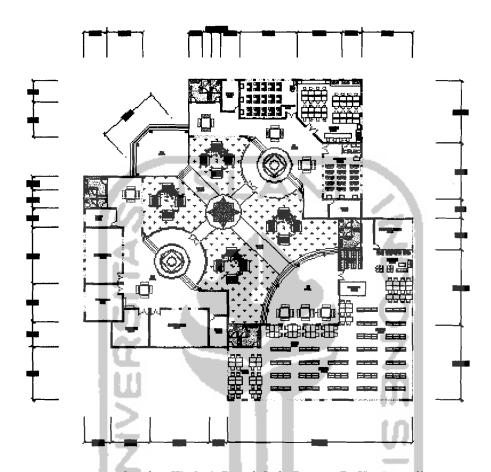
3. ii. Denah Kantor Lantai 2
